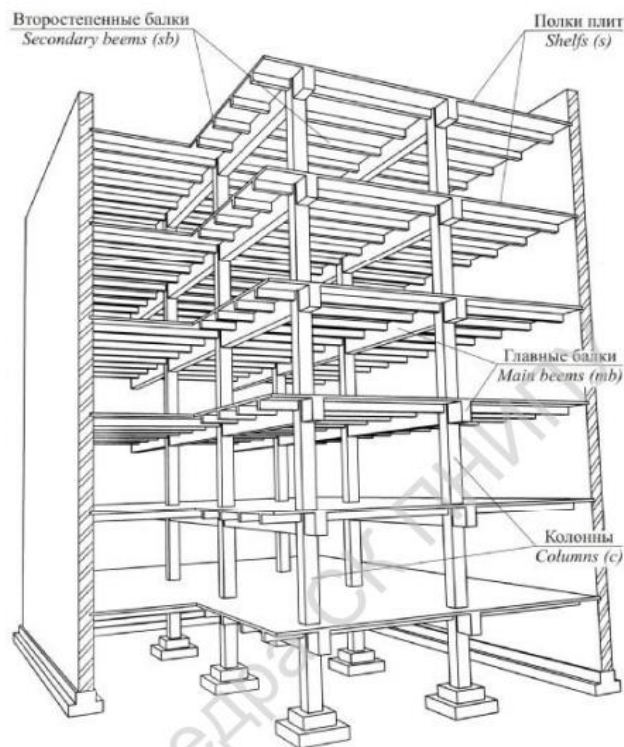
Перспектива здания с неполным железобетонным каркасом и монолитными ребристыми перекрытиями
